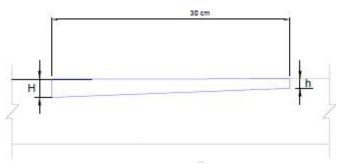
Sección transversal de GSLF de tipo trapezoidal.
